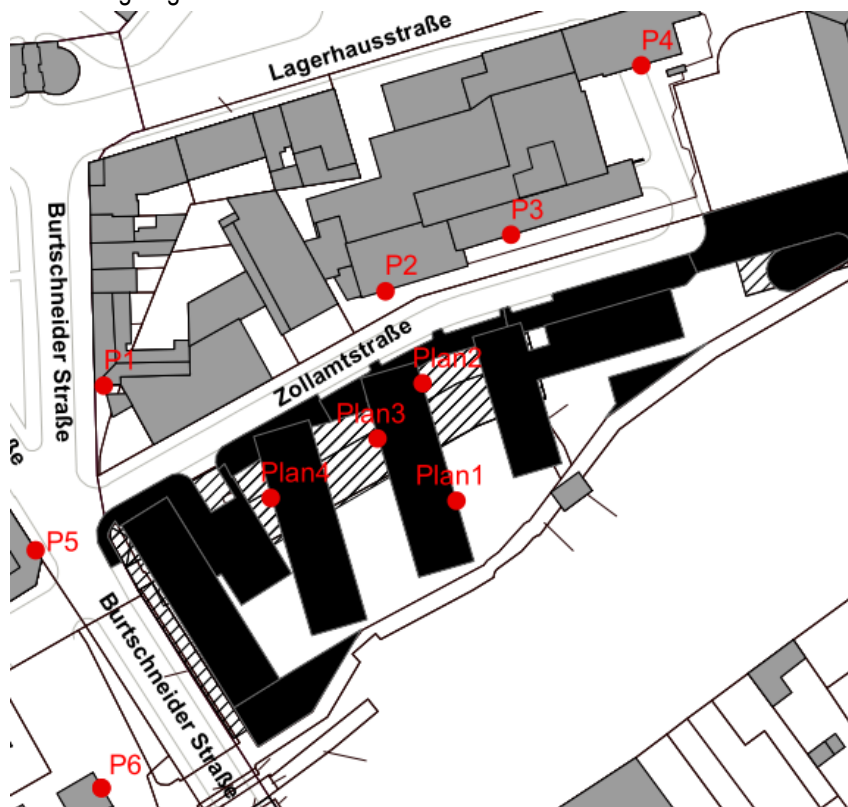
Darstellung der betrachteten Gebäude/ Standorte i.R. der Untersuchung der Beeinträchtigung der Sonneneinstrahlung (s. Fußnote 3)
